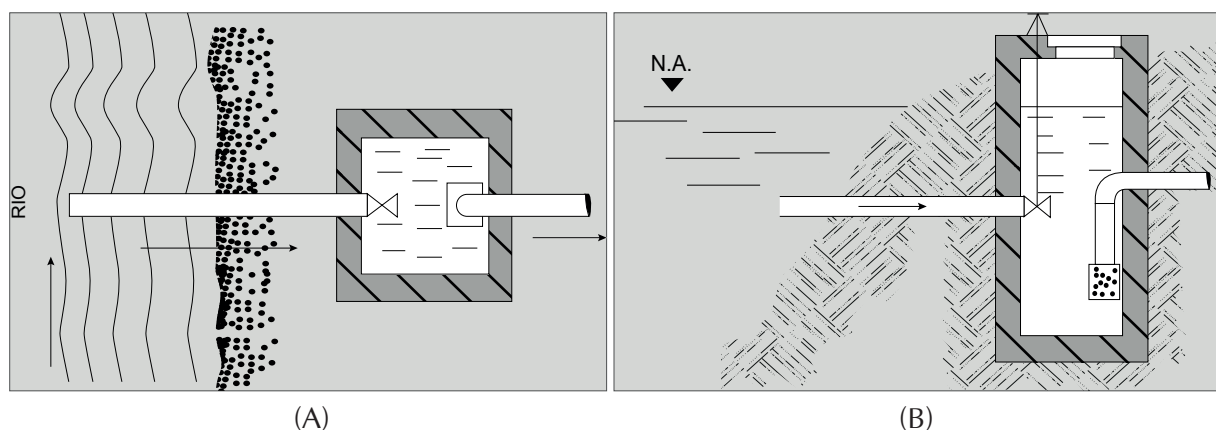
Tipo de poço de tomada em planta (A) e corte (B).
